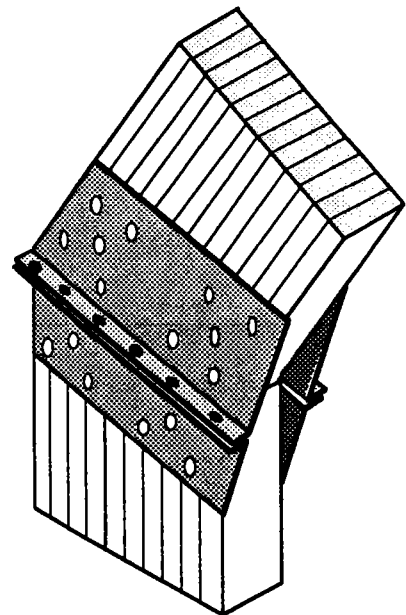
Assemblage d'angle par goussets métalliques.
